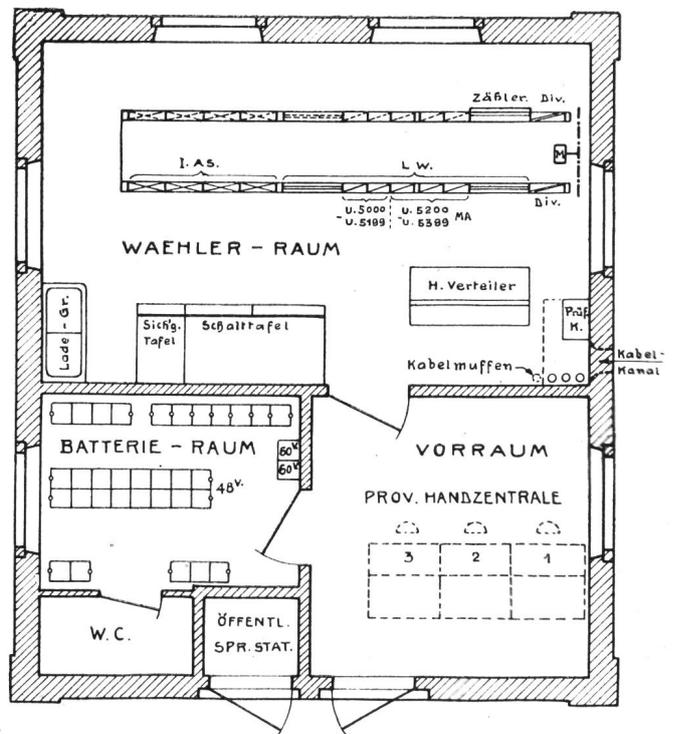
Grundriss Unterzentrale Altstetten.
